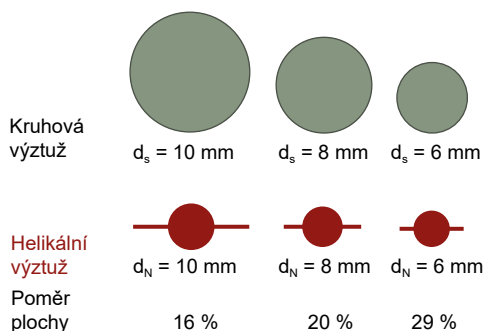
Helikální výztuž ve jmenovitých průměrech 10, 8 a 6 mm
